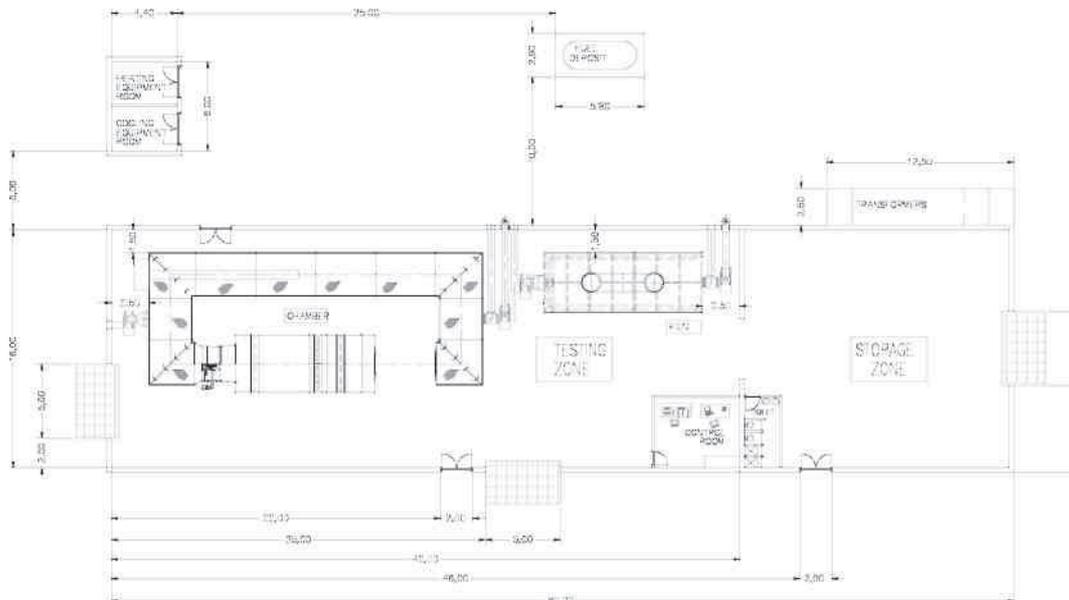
Layout degli impianti di prova al fuoco dei ventilatori assiali e dei jet fan
